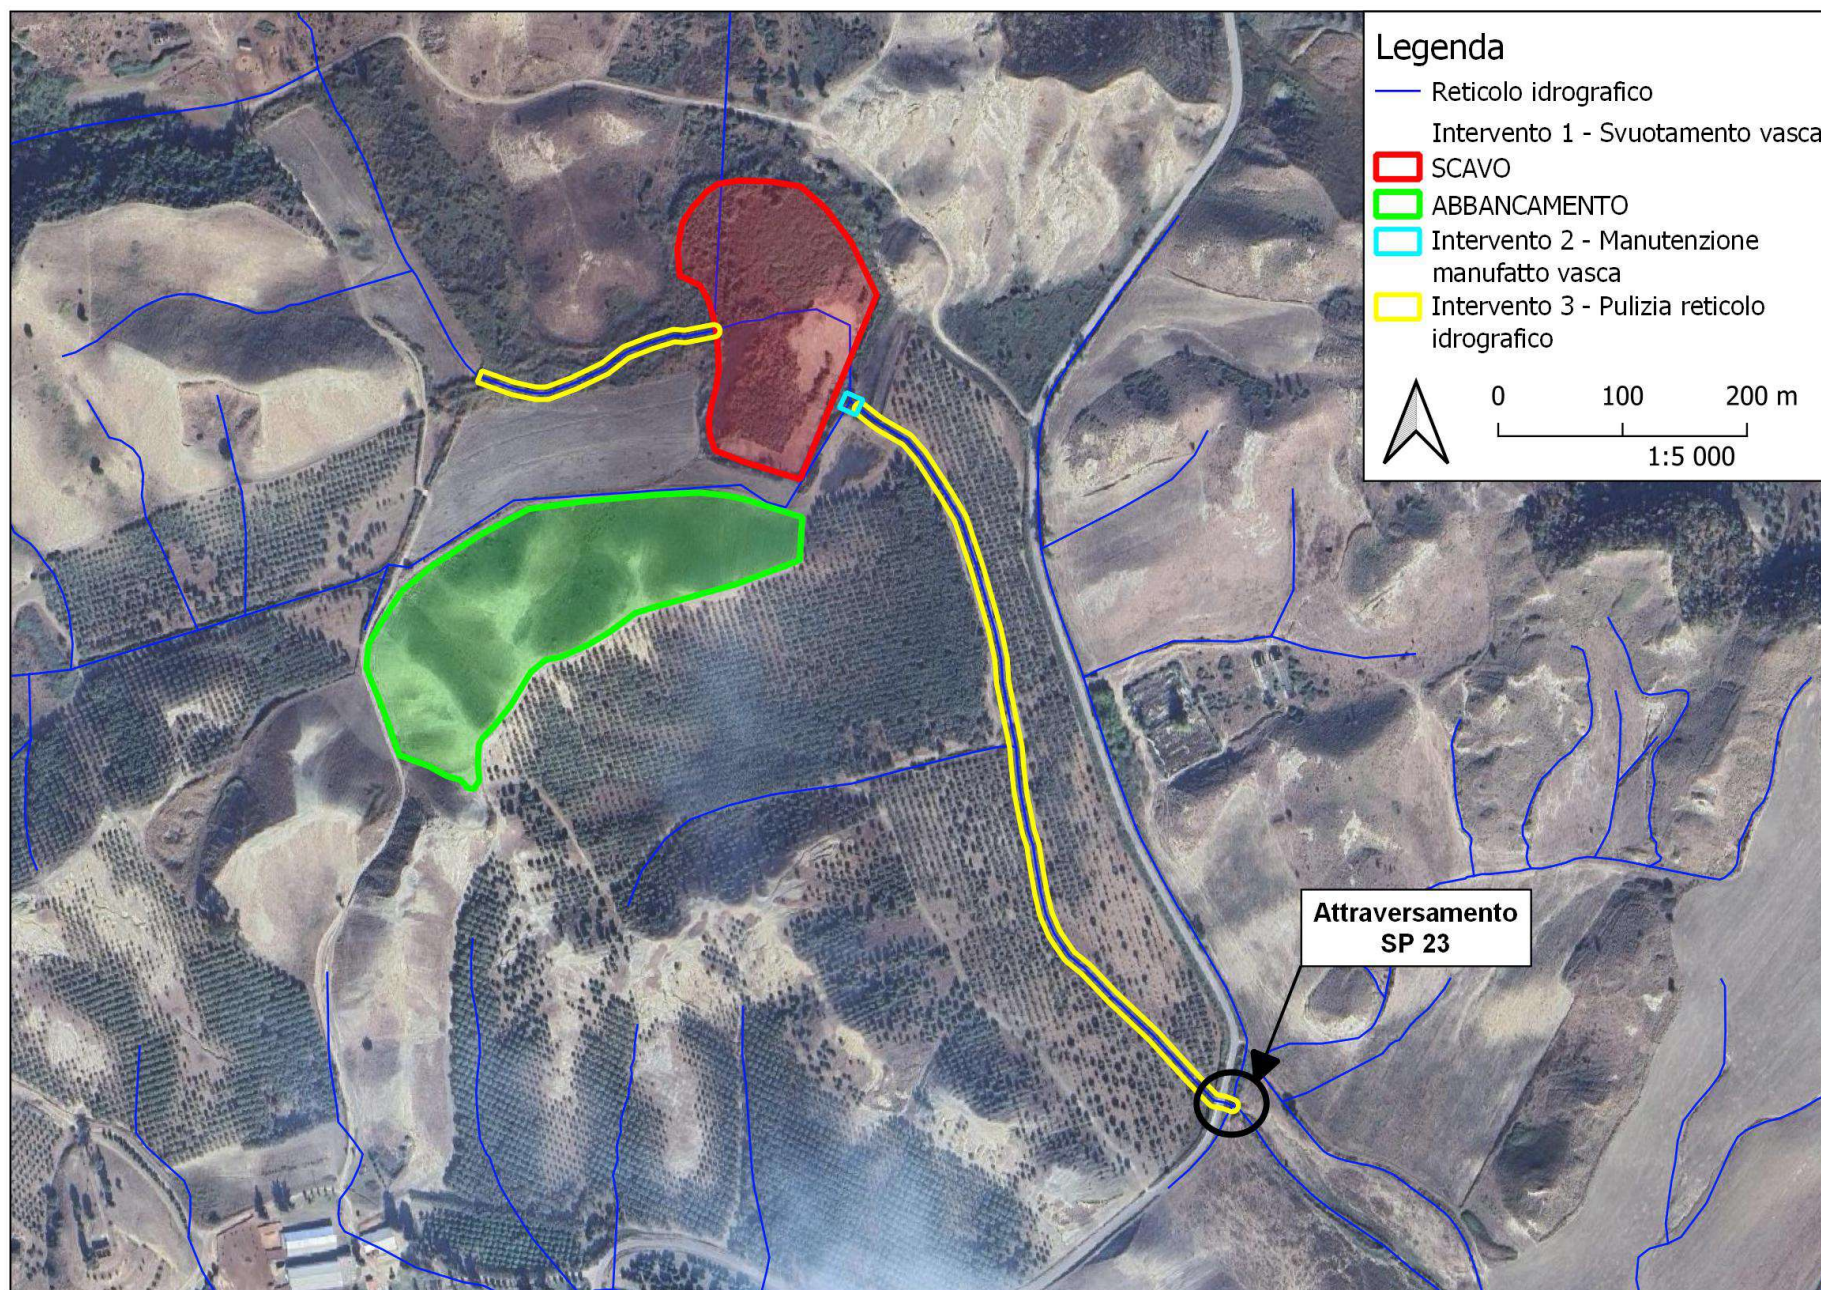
Planimetria generale con individuazione area intervento – Dettaglio con sovrapposizione ortofoto satellitare
